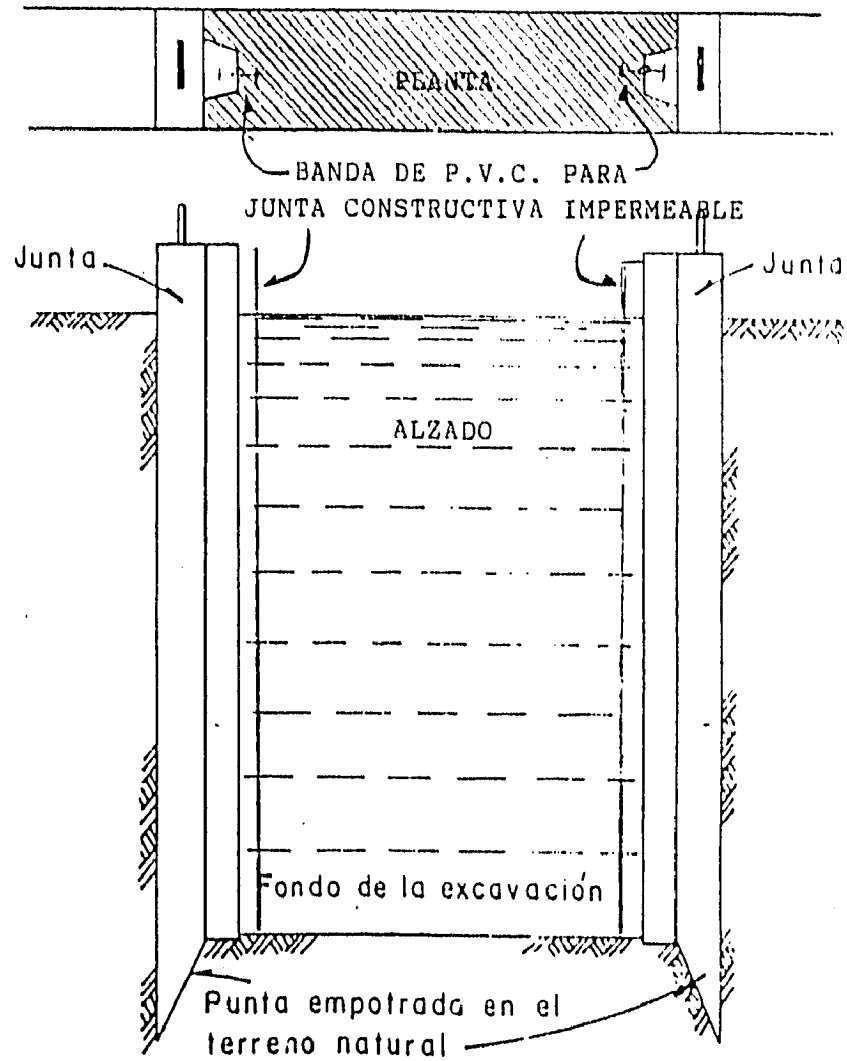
JUNTA METÁLICA MACHIMBRADA PARA MURO MILÁN
